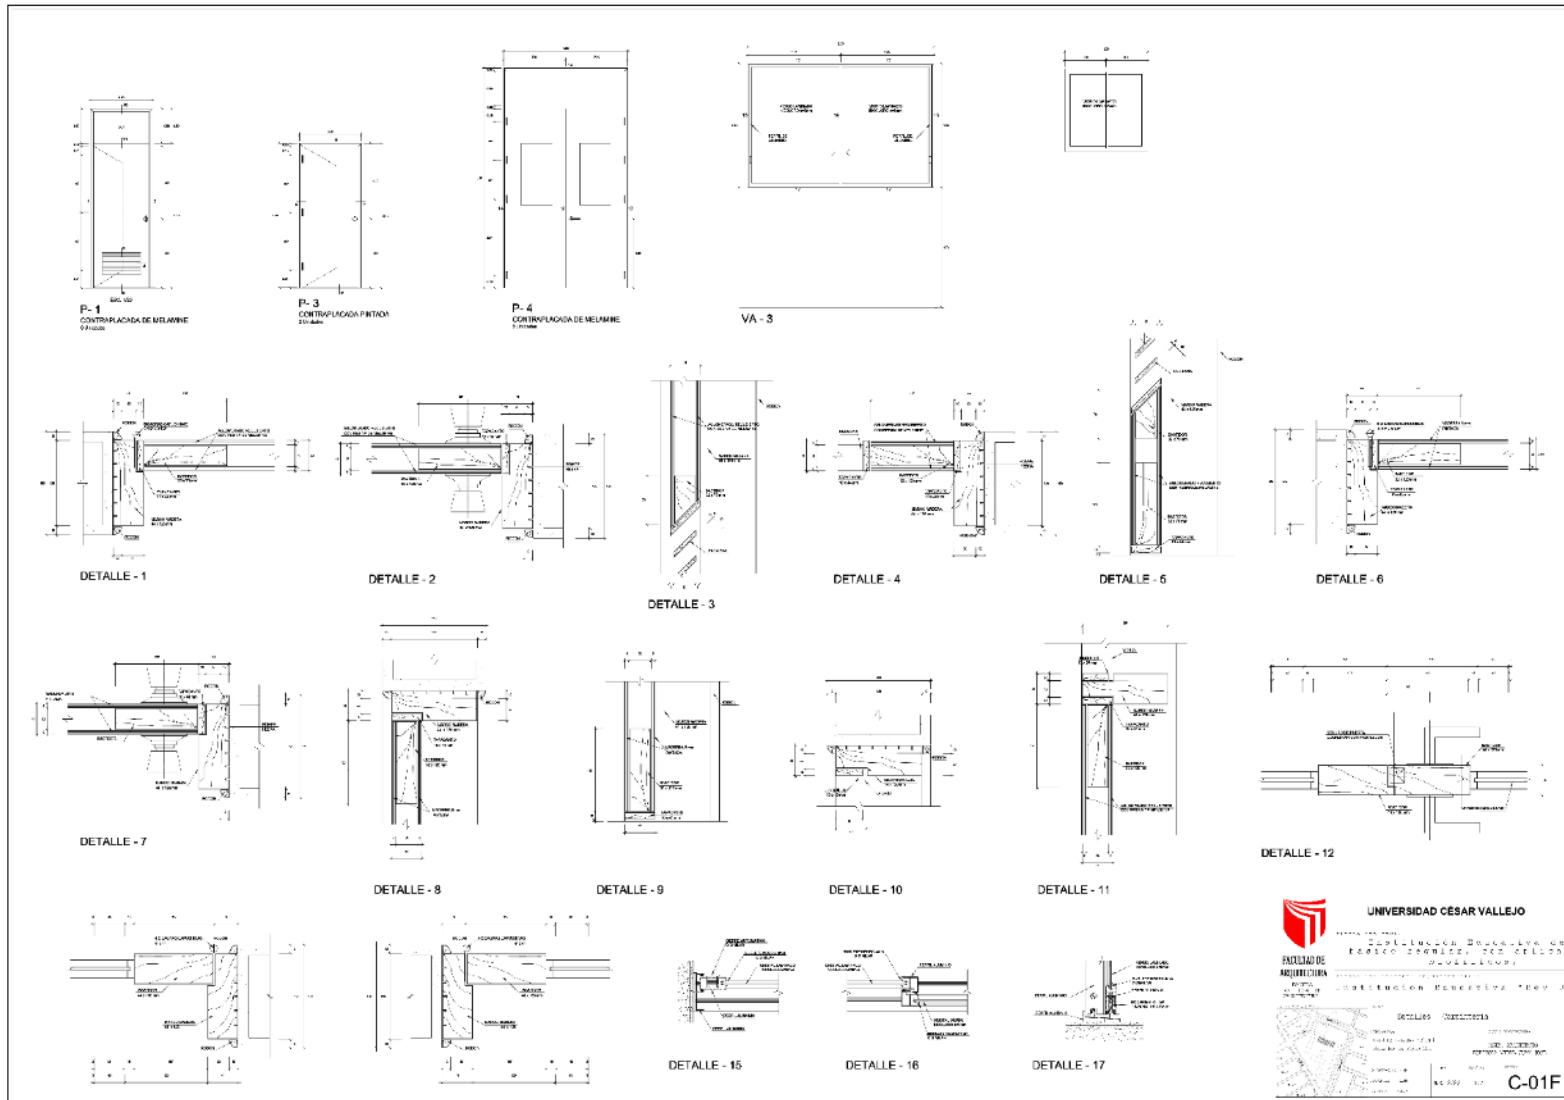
Plano Detalles de Puertas y ventanas bloque "F", Fuente: elaboración propia
